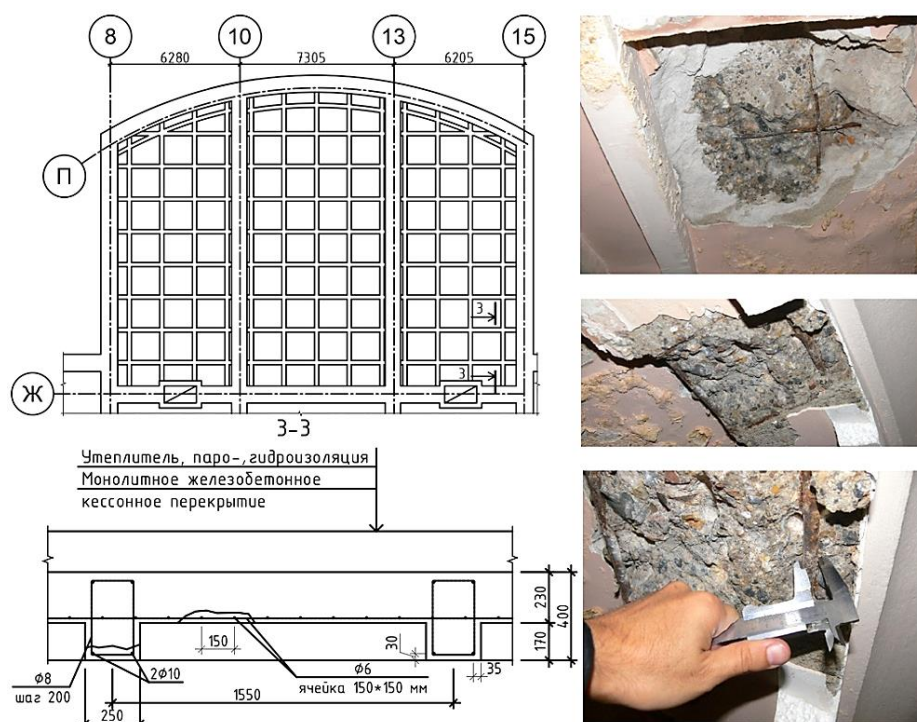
Определение конструкции перекрытия над залом второго этажа
